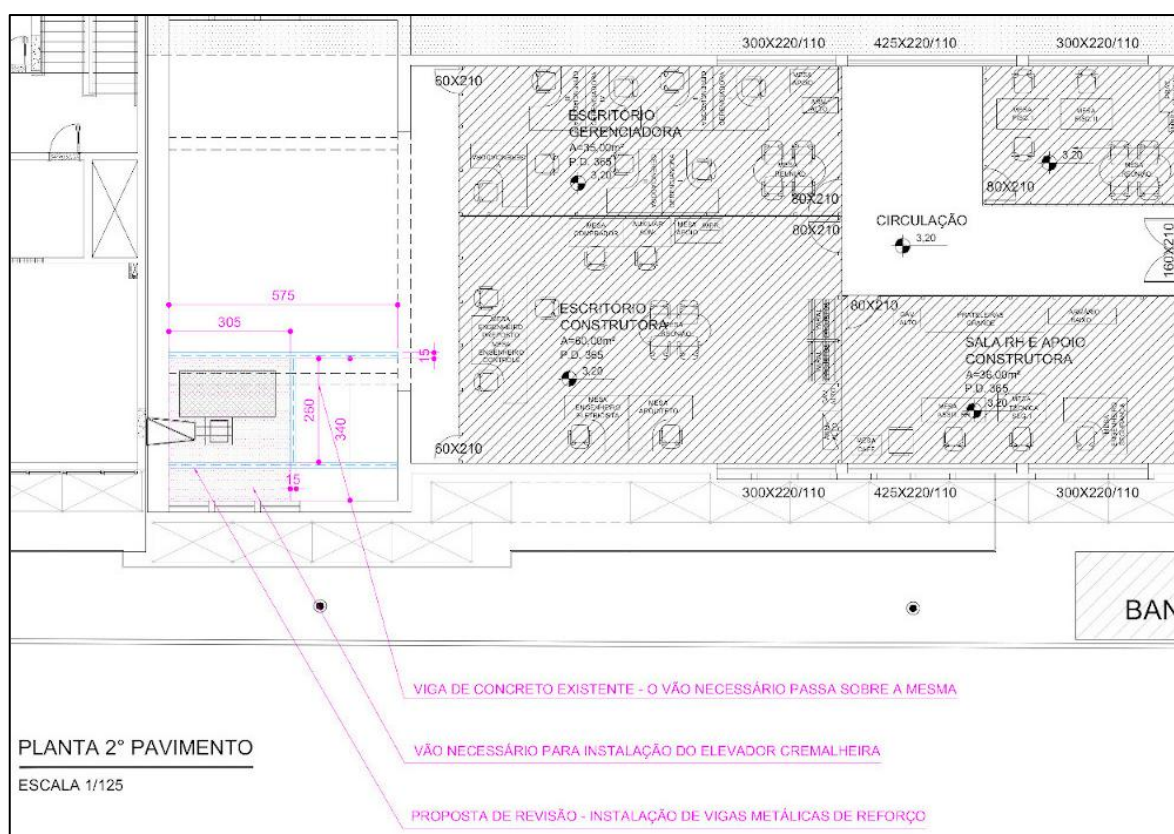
Projetos do canteiro de obras – sobreposição da revisão locação cremalheira.
